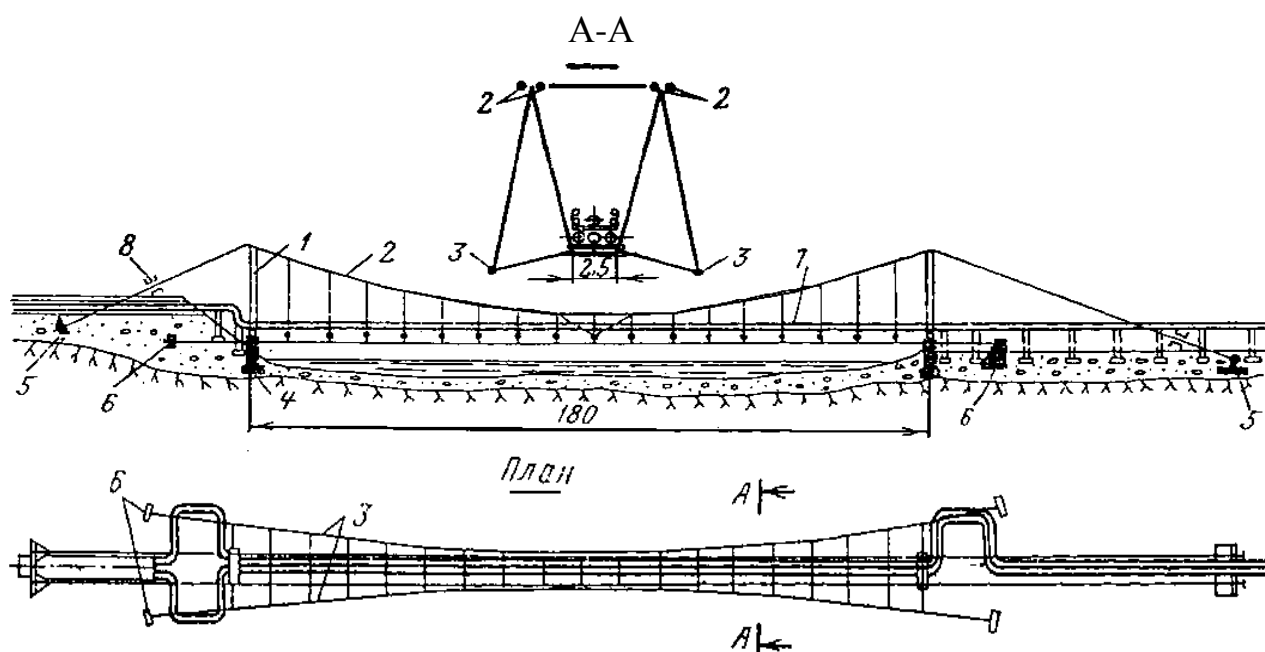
Подвесной переход теплопроводов через реку:
